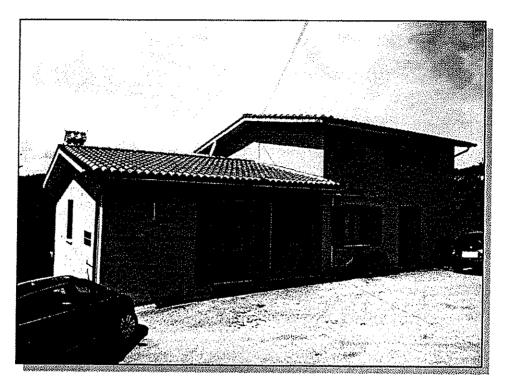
Vista esterna del fabbricato – ingresso lato est
